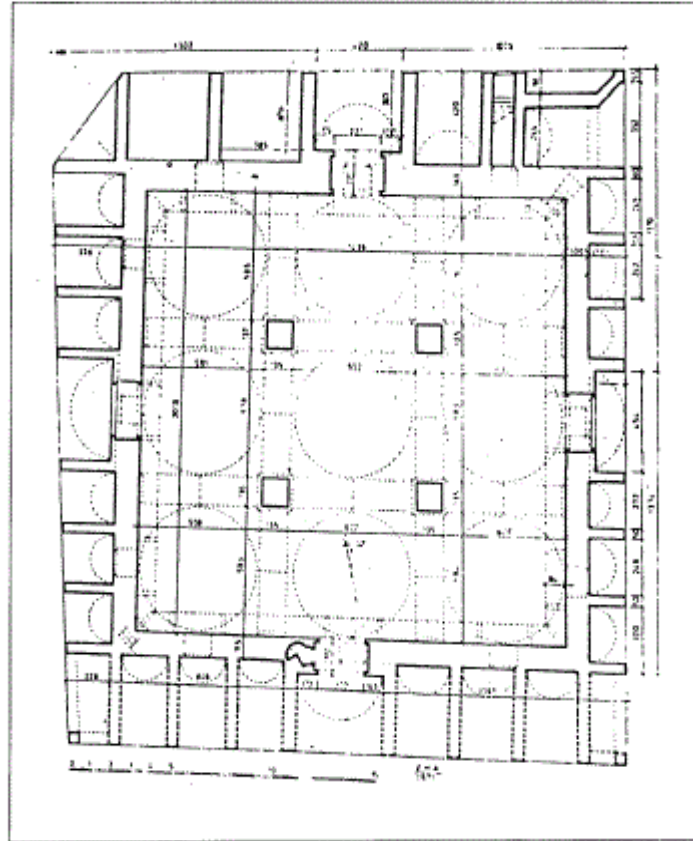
مسقط أفقي لبادستان أدرنه (عن: Cezar).
